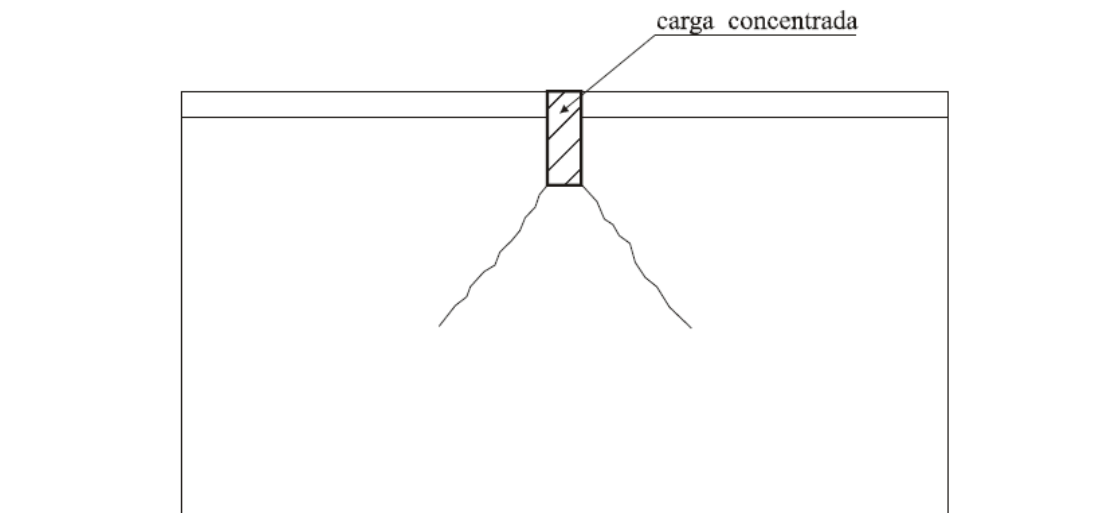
Fissura causada por carga concentrada aplicada diretamente sobre a alvenaria.
